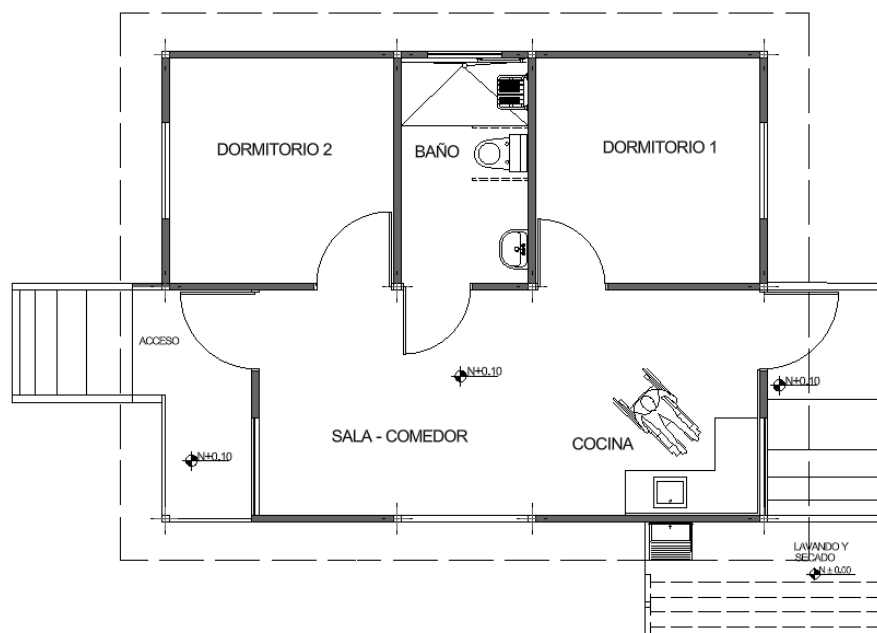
Planta arquitectónica vivienda tipo 2D (EPCPT & MIDUVI, 2019)
